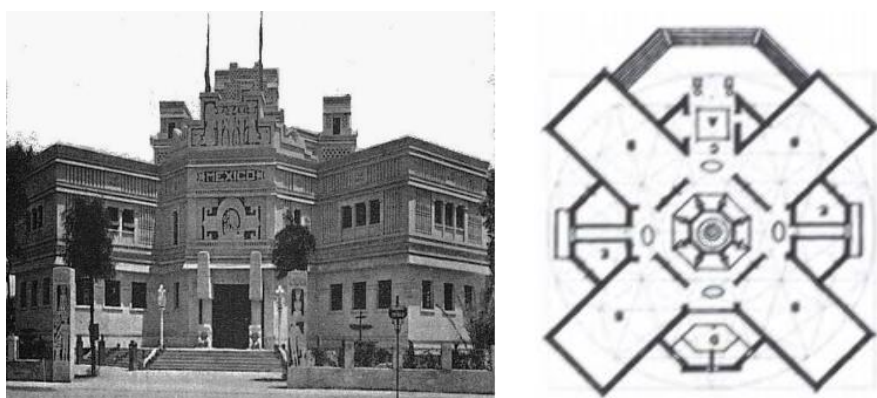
Pabellón de México, fachada de ingreso. – Figura 48: Planta primer nivel.
